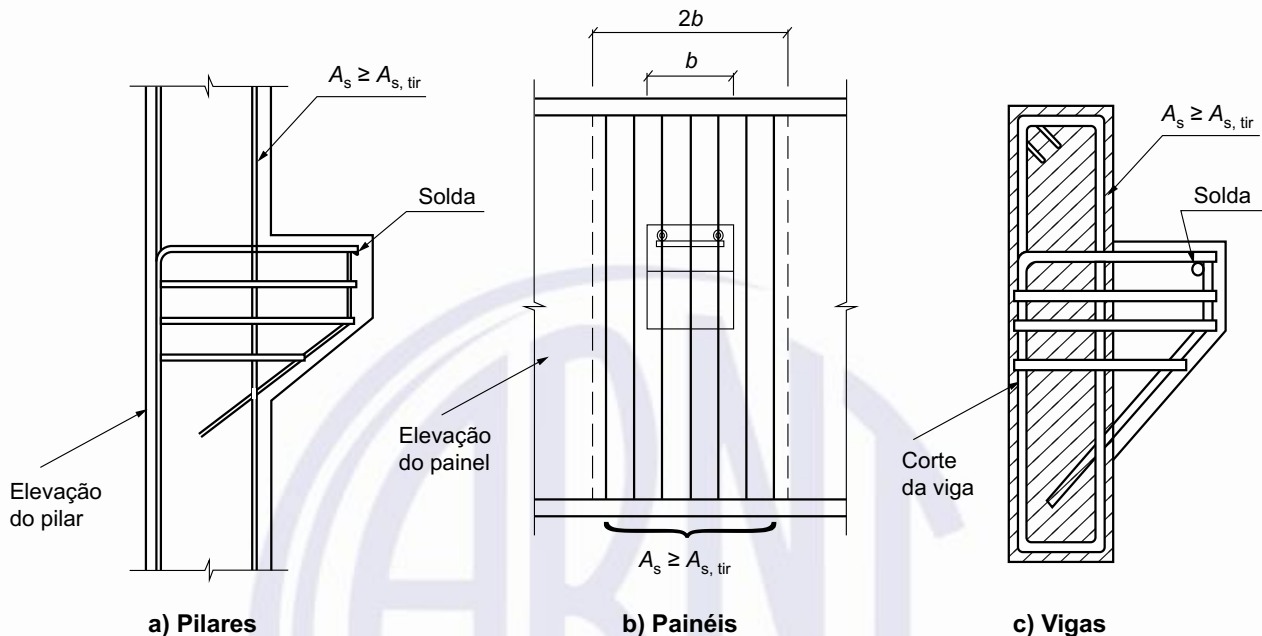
Detalhes de armadura para consolos em diferentes tipos de peças
